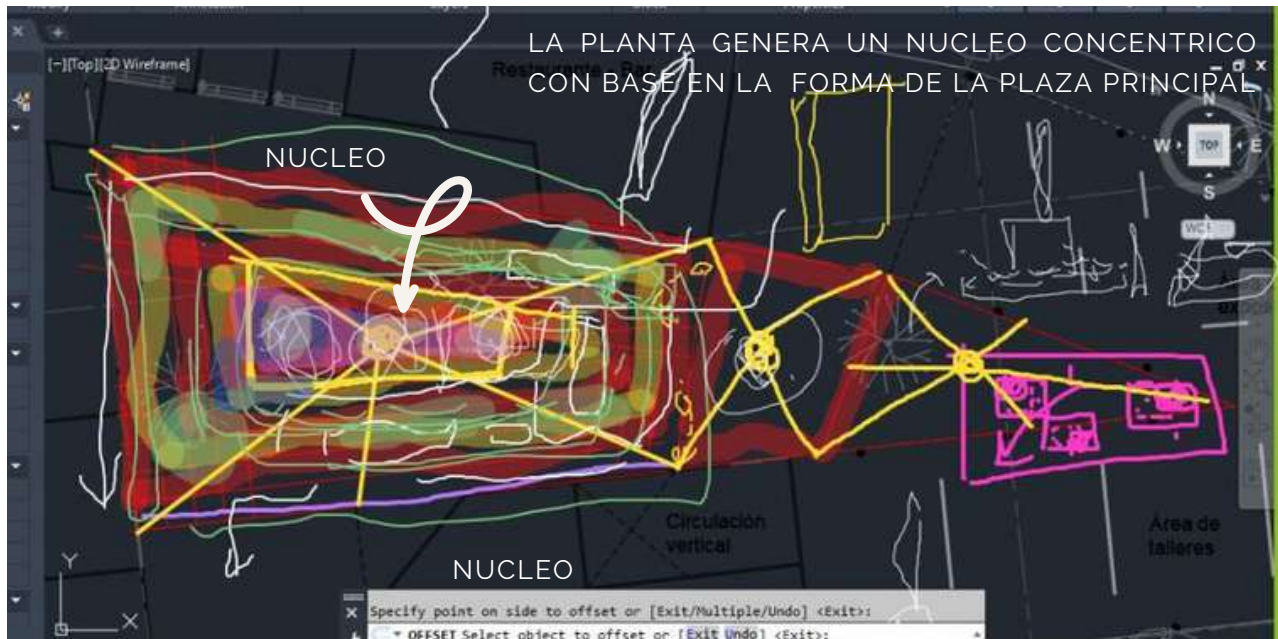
Planta arquitectónica intervenida con análisis de circulaciones. Fuente: Autoría propia
